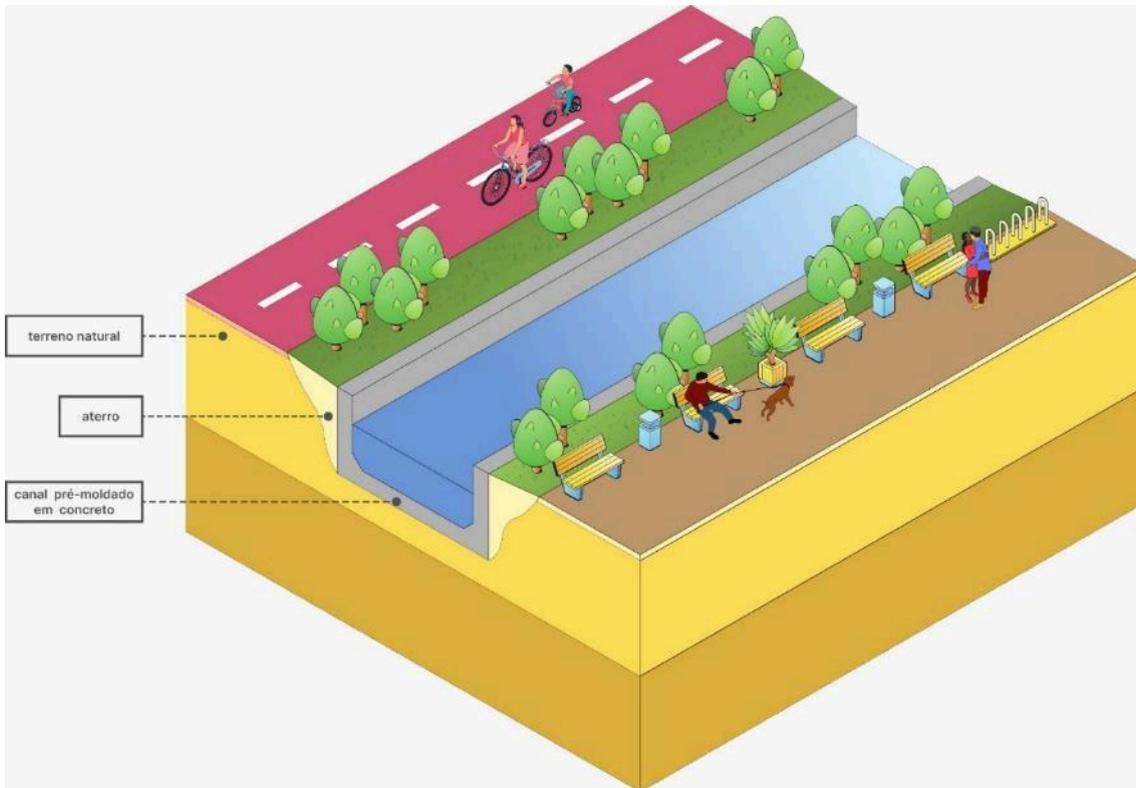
Esquema de canalização pré fabricado (Fonte: PMRR)
